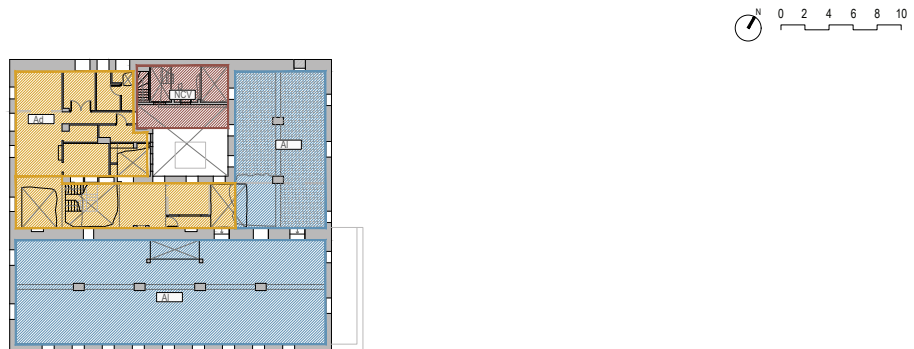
Programa de planta segunda (alternativa 1)
